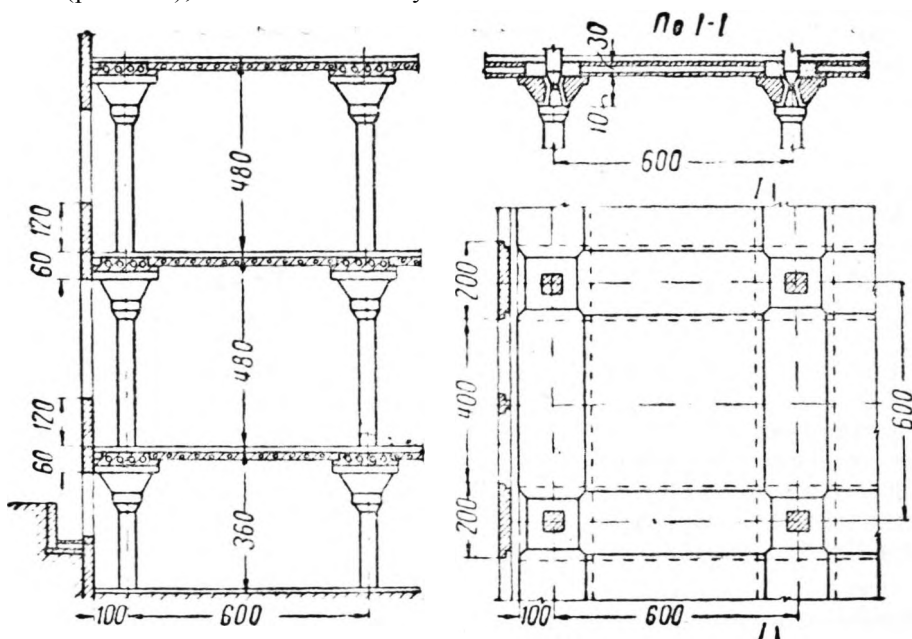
Сборный железобетонный каркас многоэтажного производственного здания по безбалочной схеме
